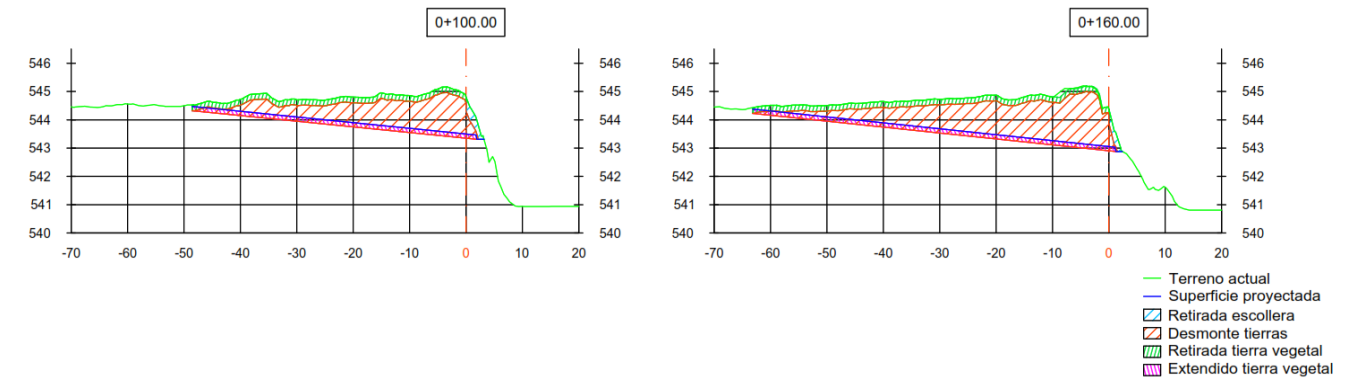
Perfiles transversales PK 0+100 y 0+160 del tramo 1:2
